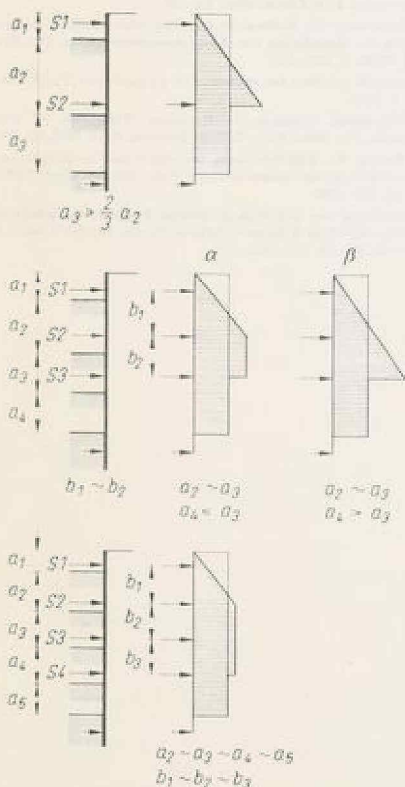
Erddruck ohne Hauslast E_0 -Fläche, Grundformen
